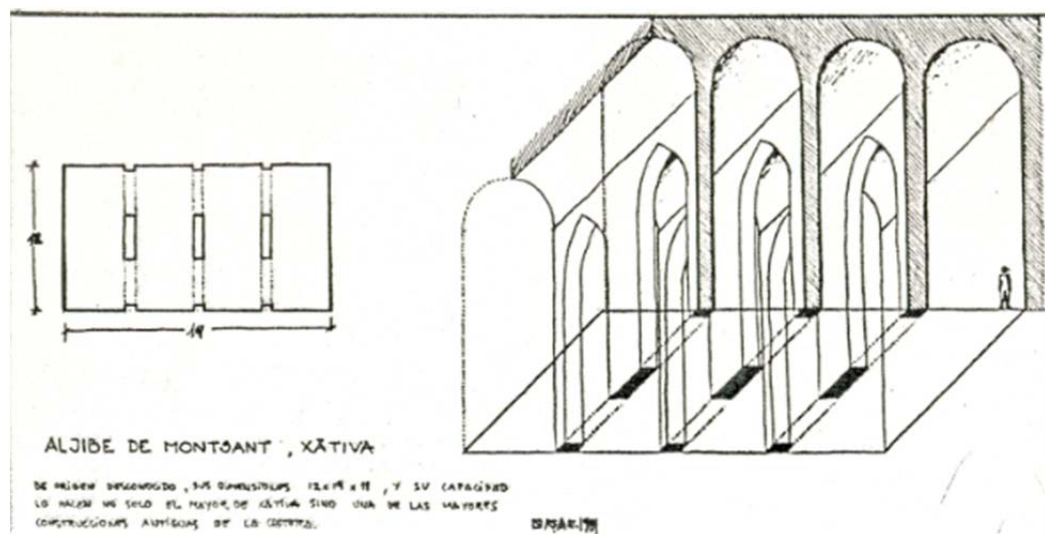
Croquis alzado y planta del Aljibe de Montsant. 1981. R. SICLUNA- A. ZARAGOZA
